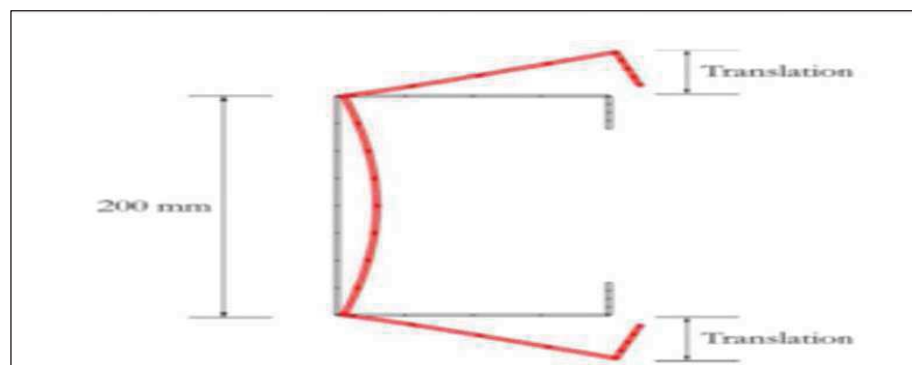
Instabilité distorsionnelle d'une section en C.
